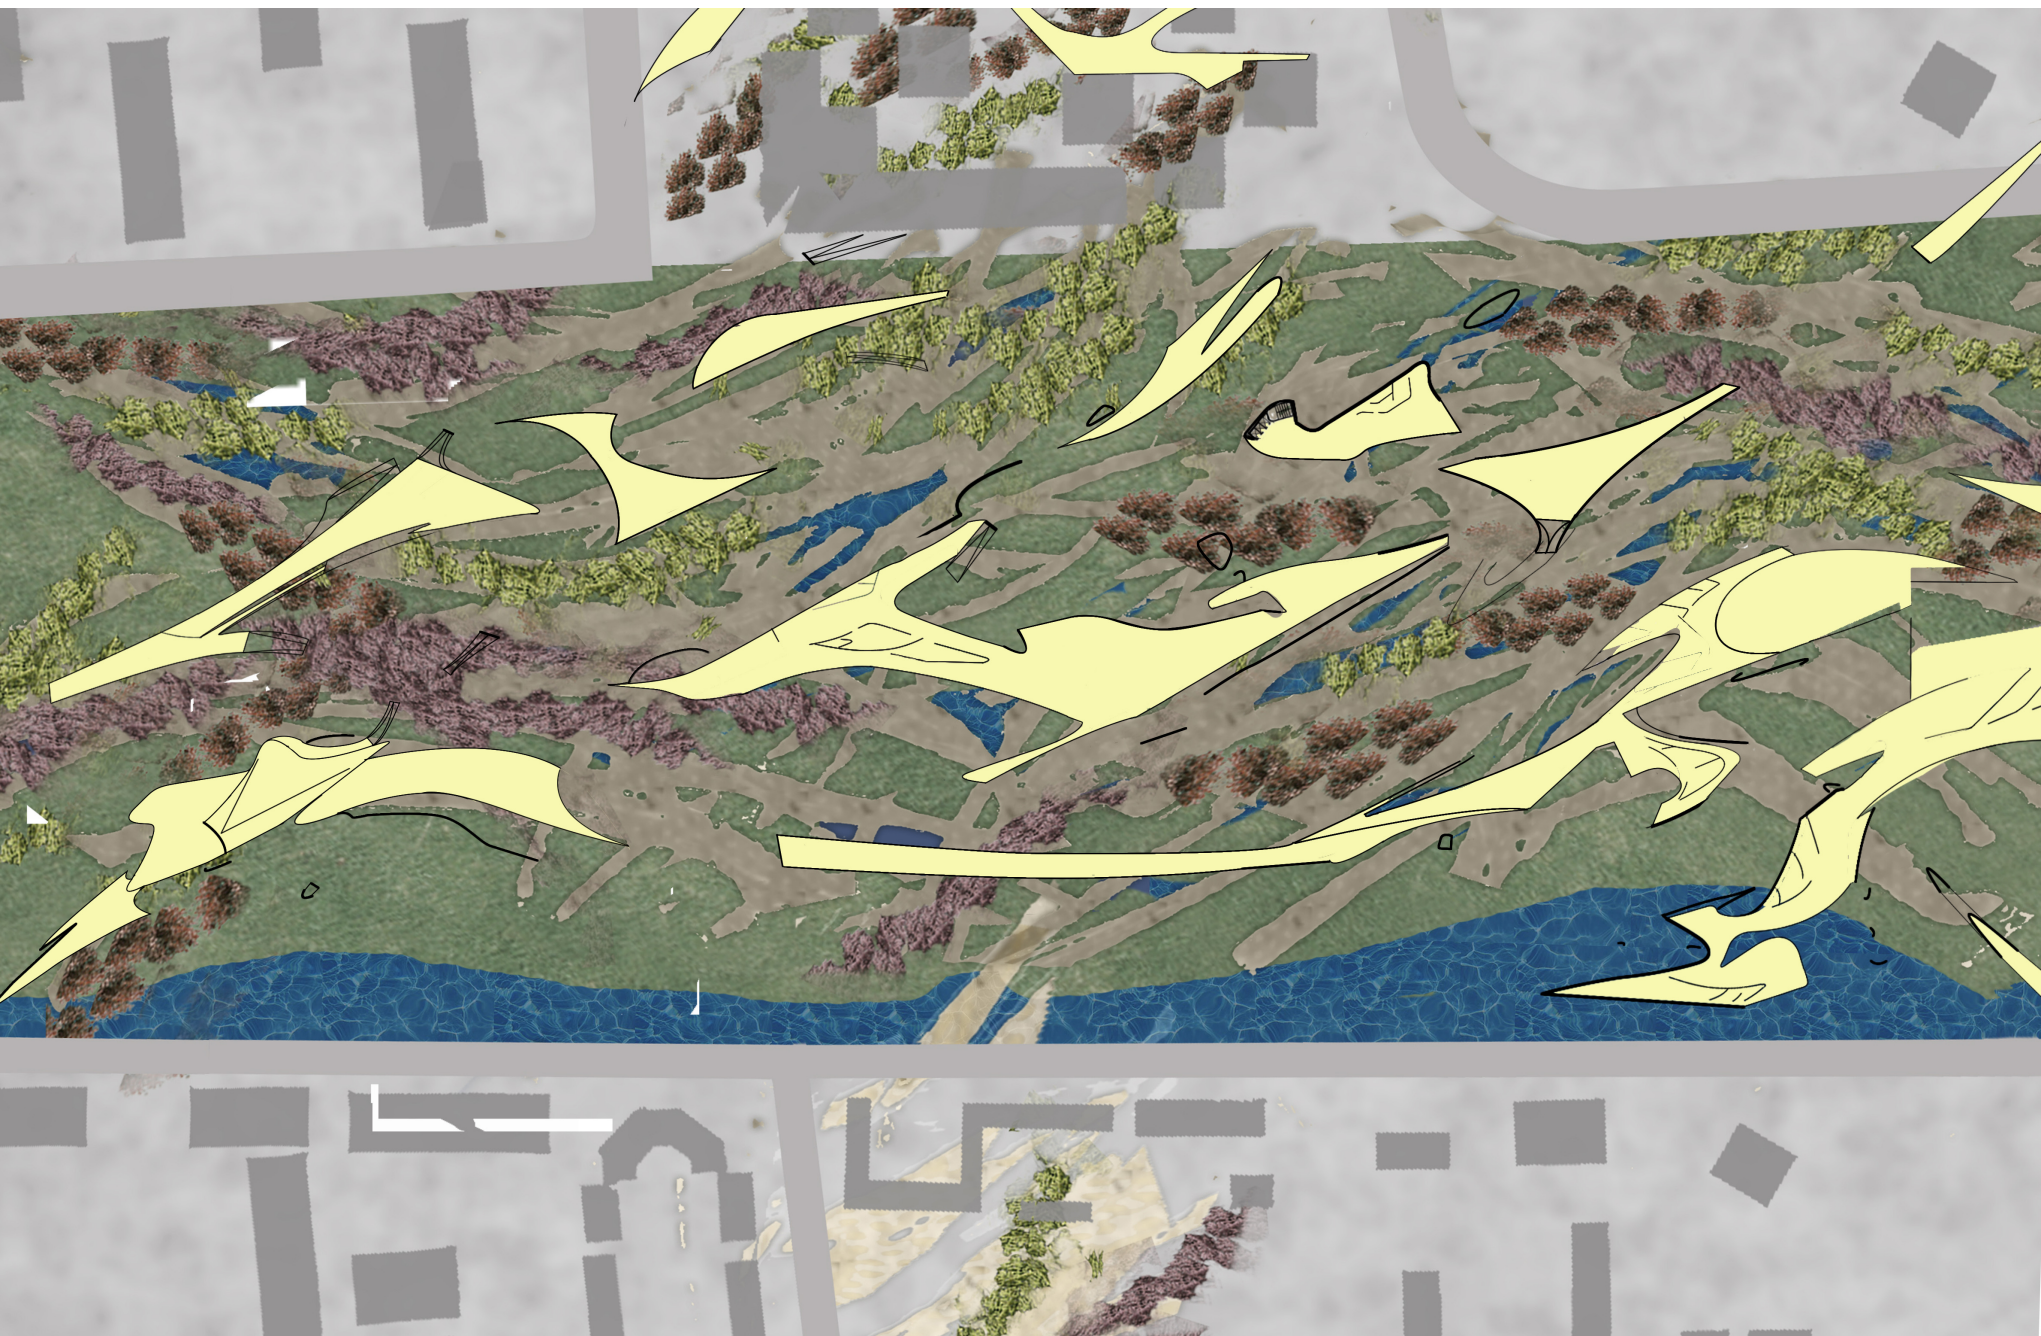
Sviluppo planimetrico della componente attività/attività-attività/spazio - Pianta del piano terra in scala 1:500
